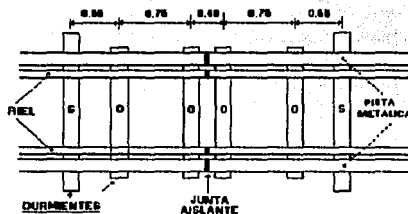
COLOCACION DE JUNTA AISLANTE PARA PISTA METALICA
